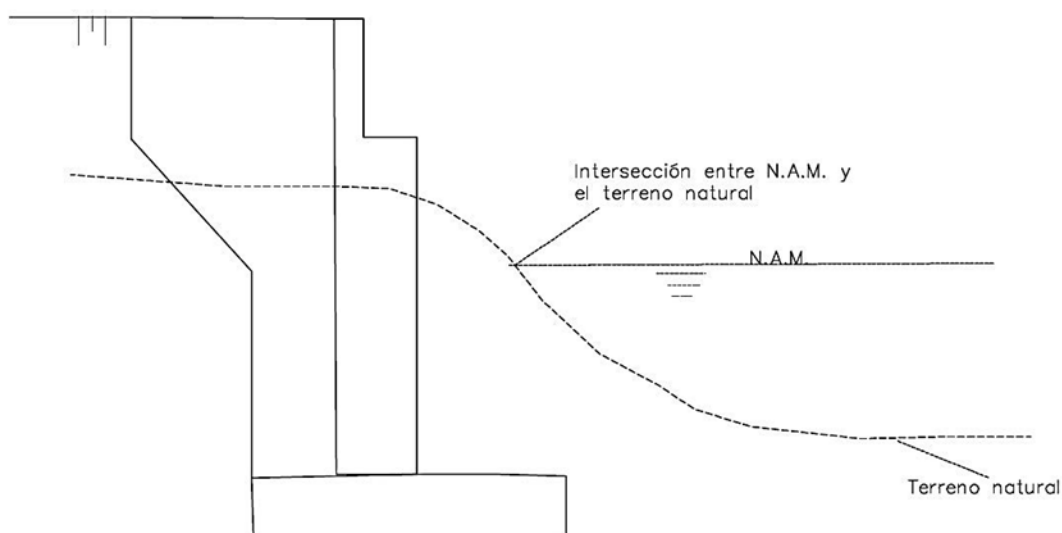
Ubicación de los estribos del puente respecto a los márgenes del río y taludes de la carretera
